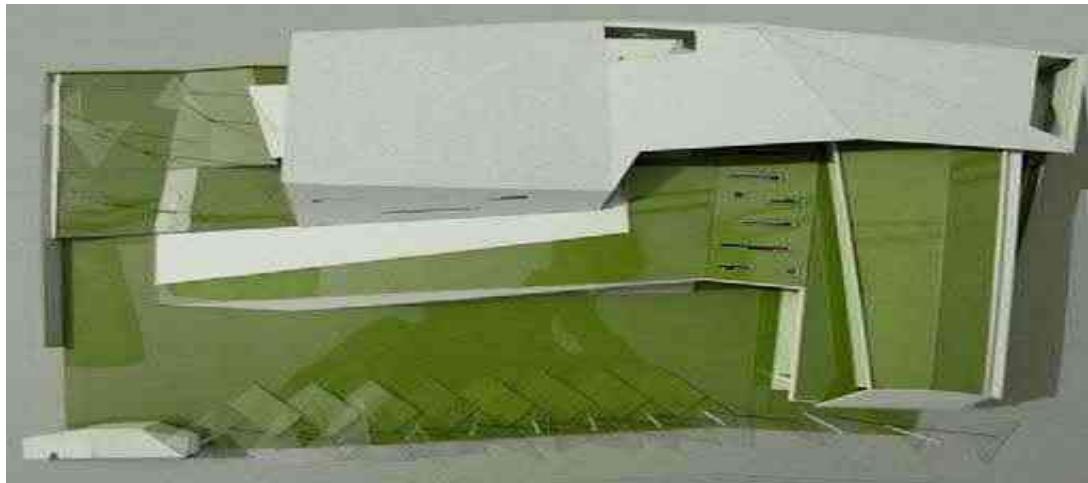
Bangunan Kantor Trafacon Office Building, Jakarta
